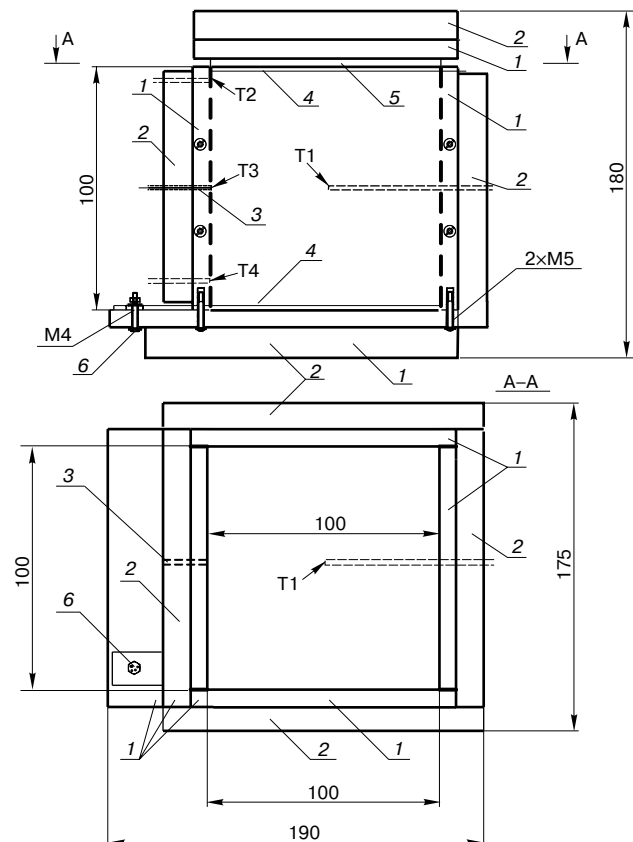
Опалубка для изготовления и электротепловой обработки образцов бетона 100×100×100 мм: 1 – стенки (ламинированная фанера 12 мм или стеклопластик 10 мм); 2 – теплоизоляция (пенопласт 20–25 мм); 3 – отверстия для термопары; 4 – электроды; 5 – эластичная прокладка; 6 – электрический зажим нижнего электрода. Вид сбоку (верхняя проекция) показан без теплоизоляционного покрытия
